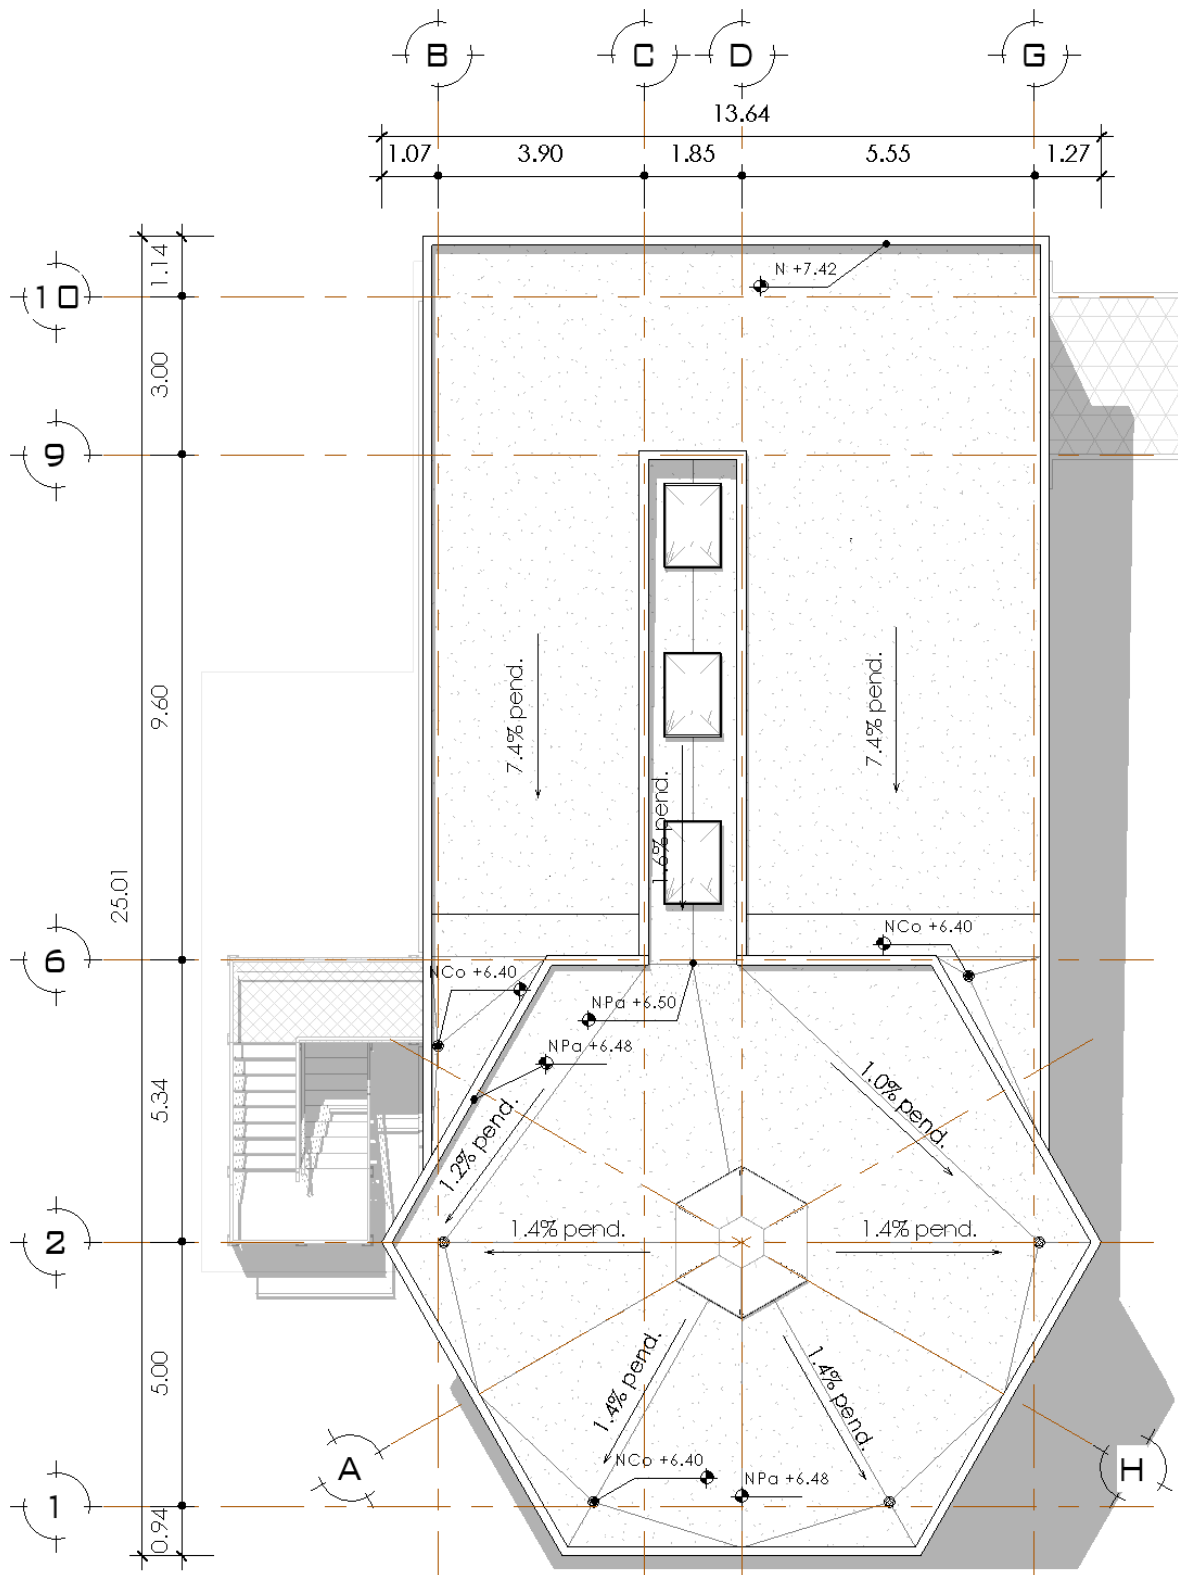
Planta arquitectónica de azotea (ver detalle en plano A-ARQ-03).
